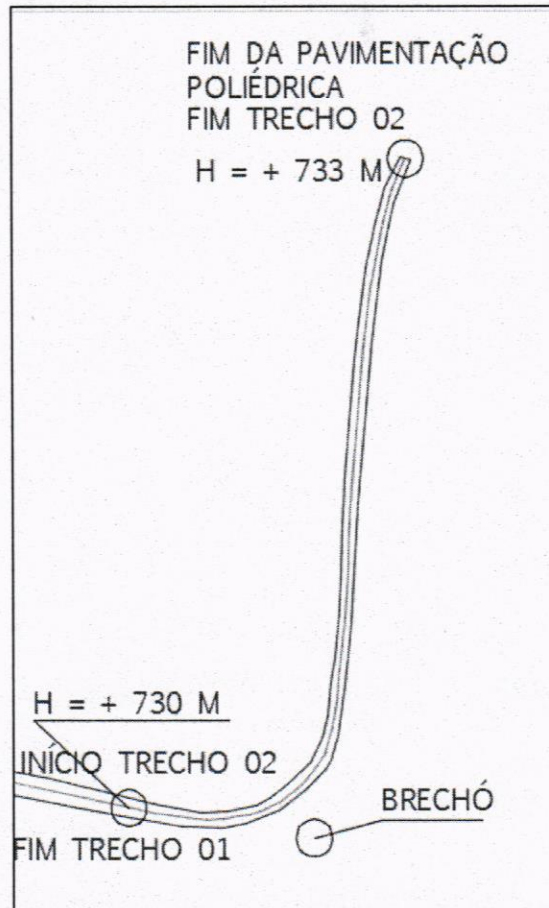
Perfil Longitudinal do Pavimento - Cruzamento
